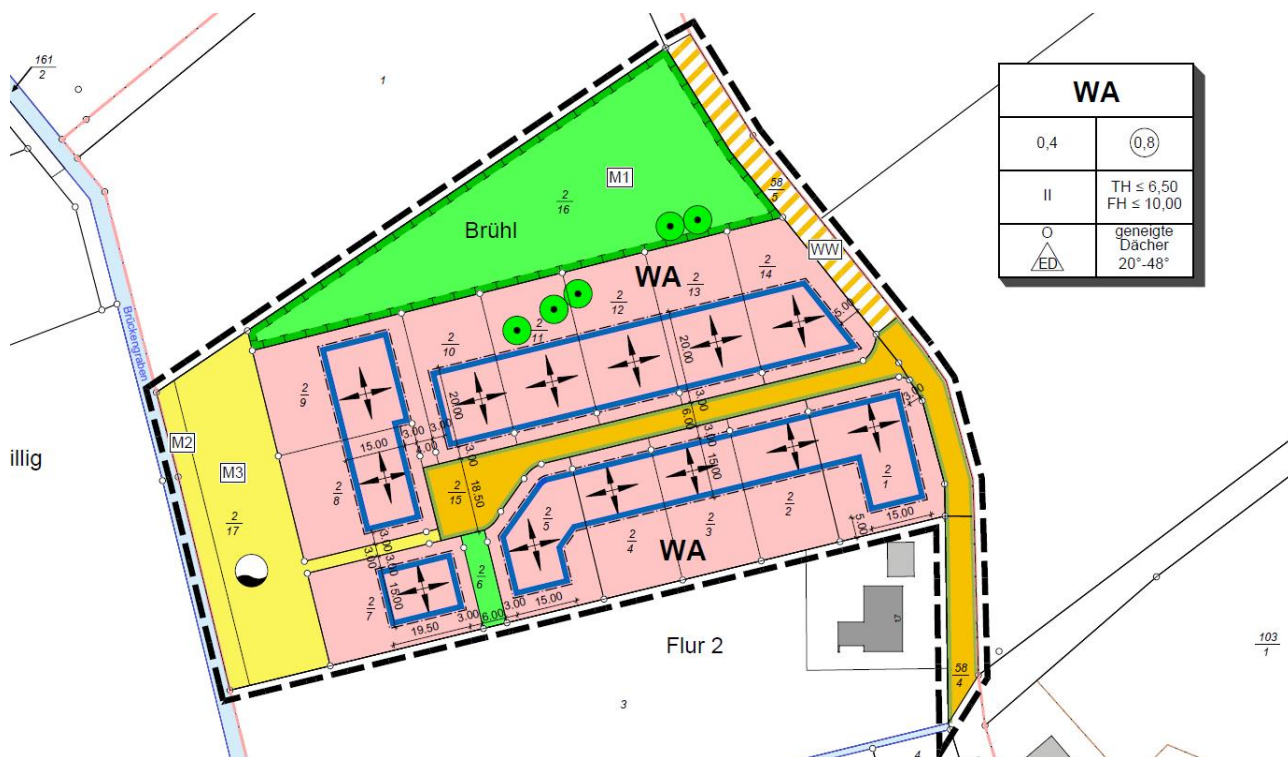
Darstellungen mit kleineren Änderungen zum Entwurf
